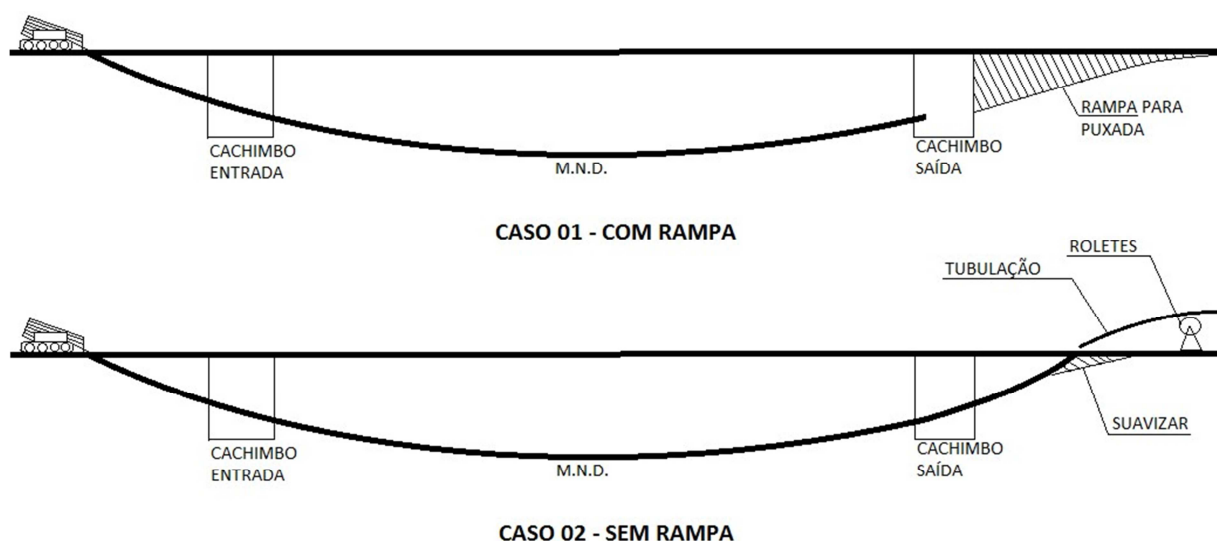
Ilustração de perfil de M.N.D. com ou sem rampa.
